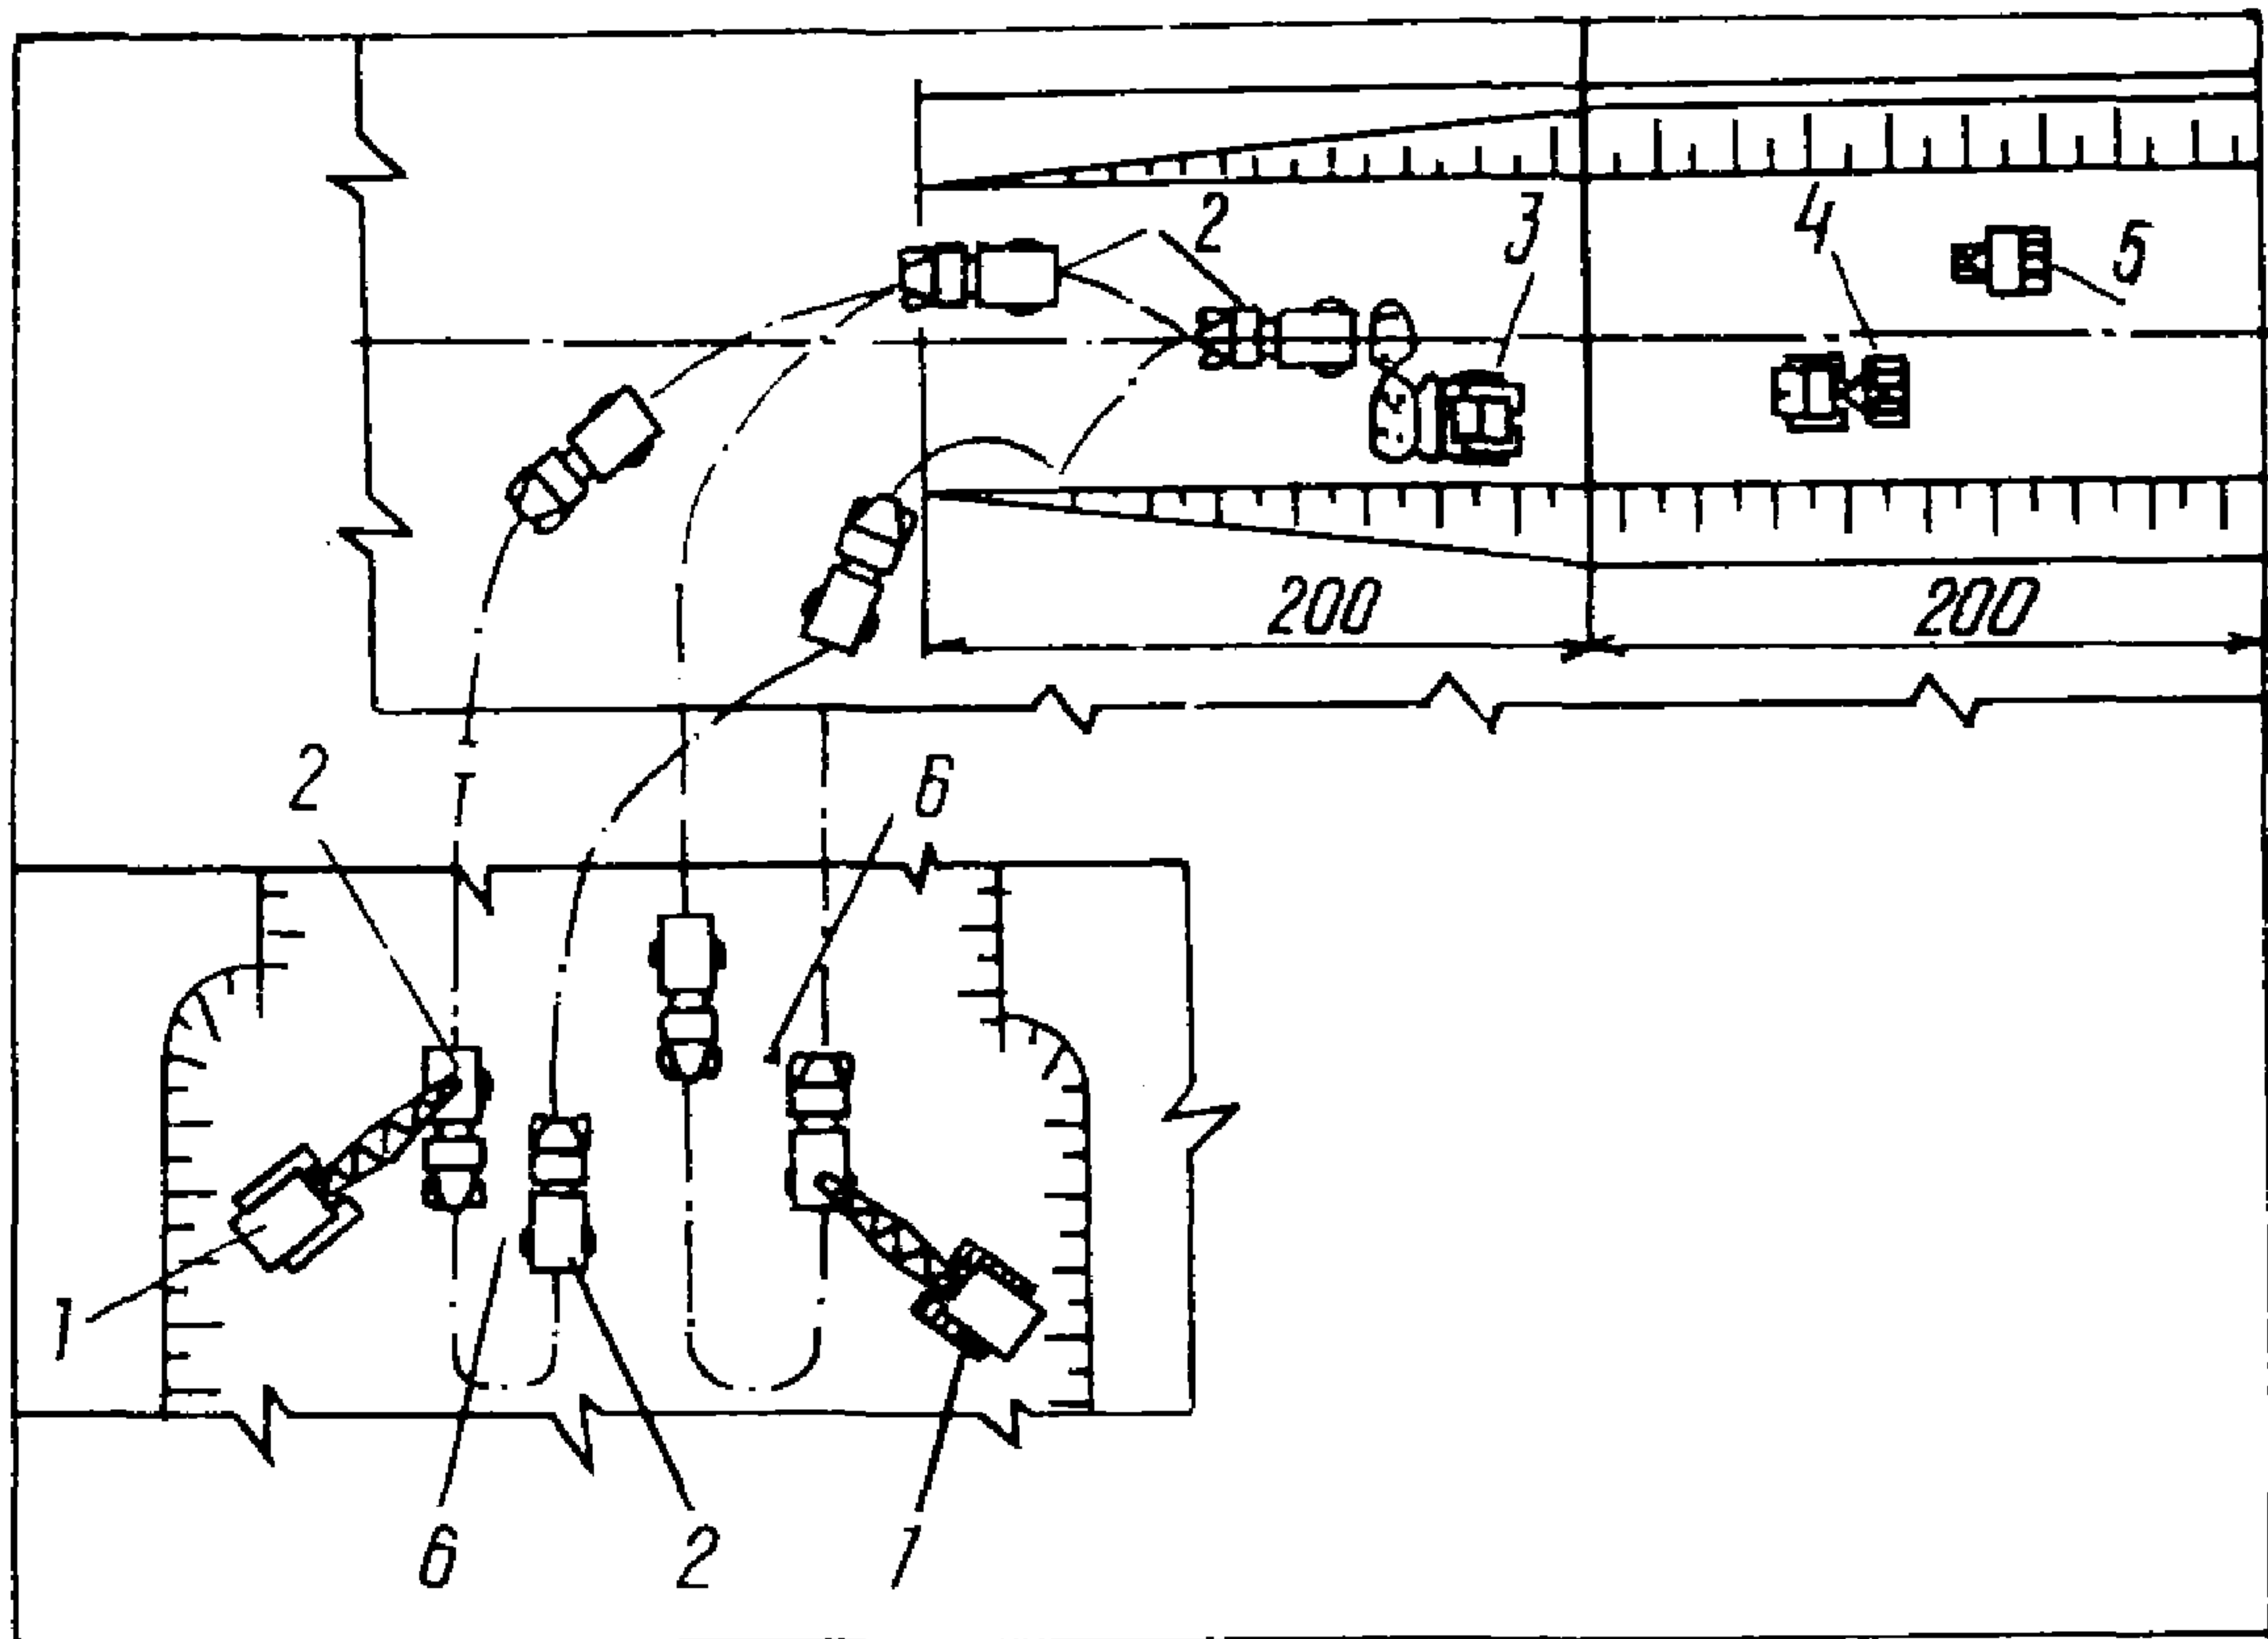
Схема возведения земляного полотна с разработкой грунта экскаваторами Э-1252Б и перемещением автомобилями-самосвалами:
